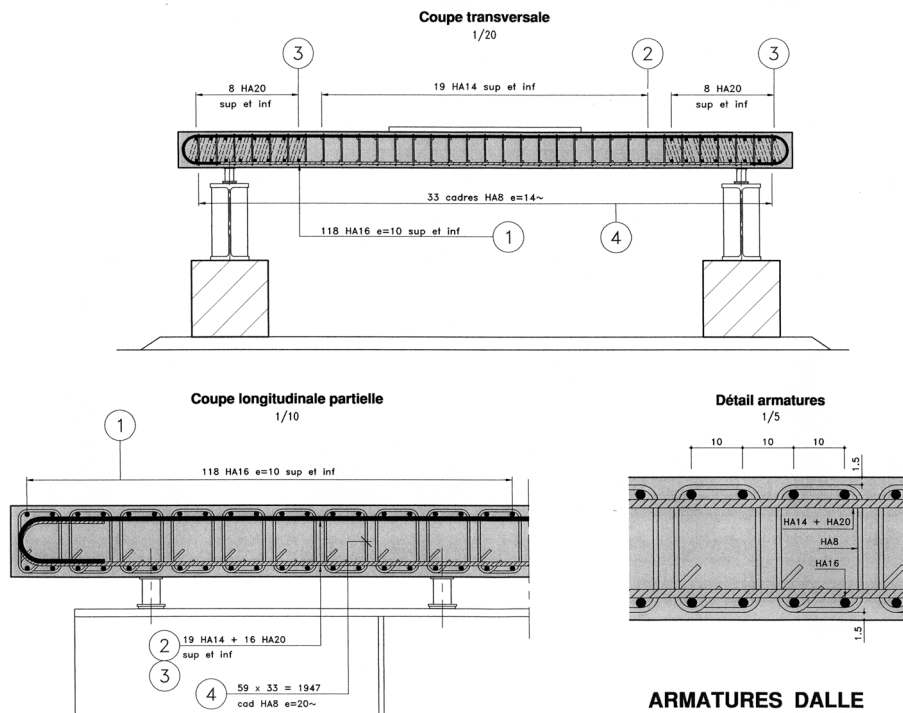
Ferrailage de la dalle PSD [Tonello 2001]
